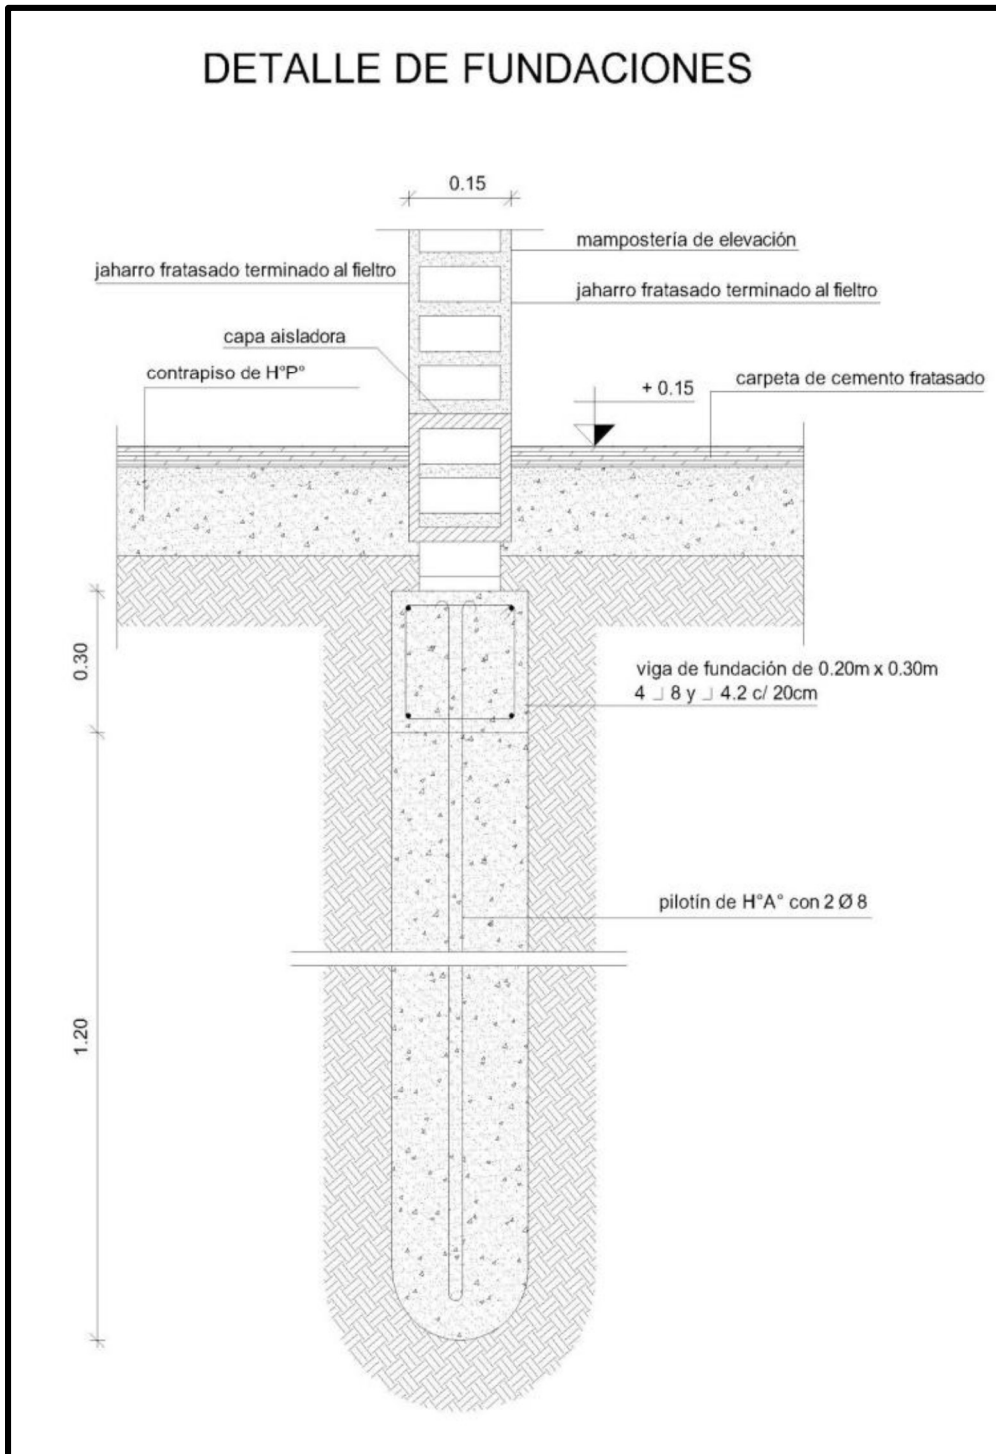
Detalle constructivo de fundación tipo viga de encadenado y pilotín (fuente: IPDUV).
